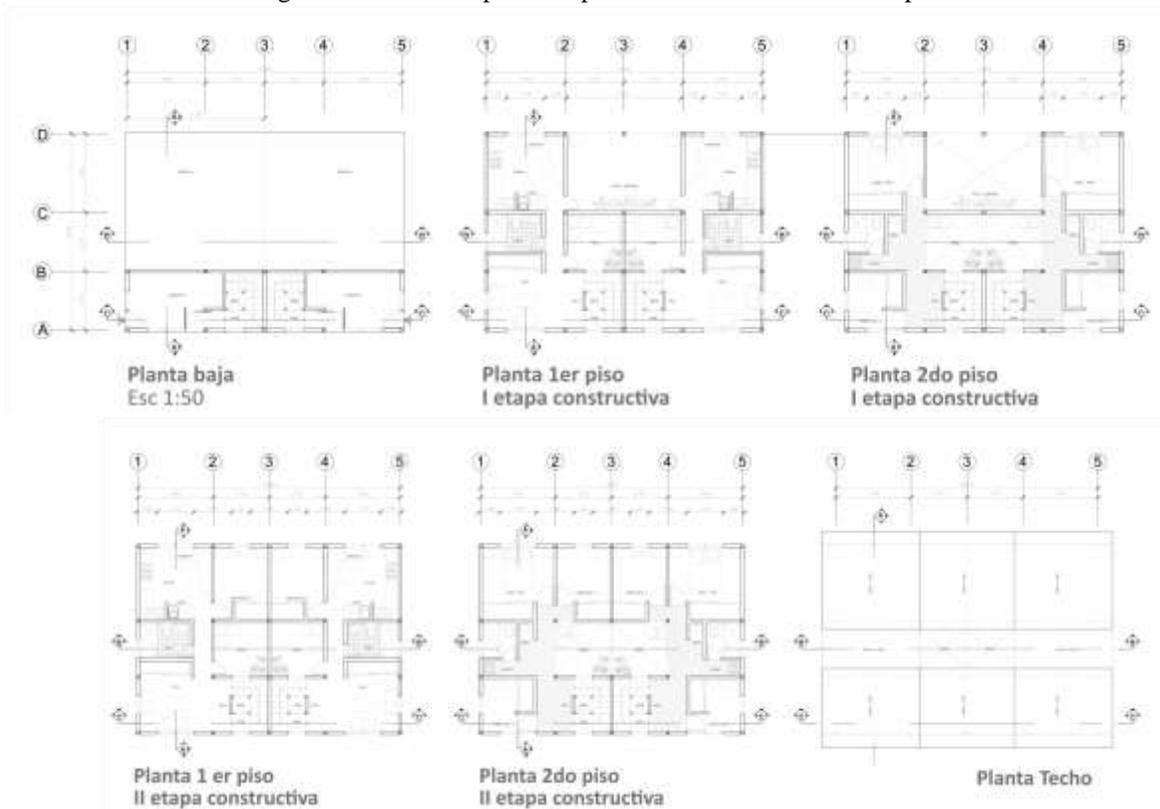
Plantas Propuesta Tipo B. Fuente: Elaboración Propia
